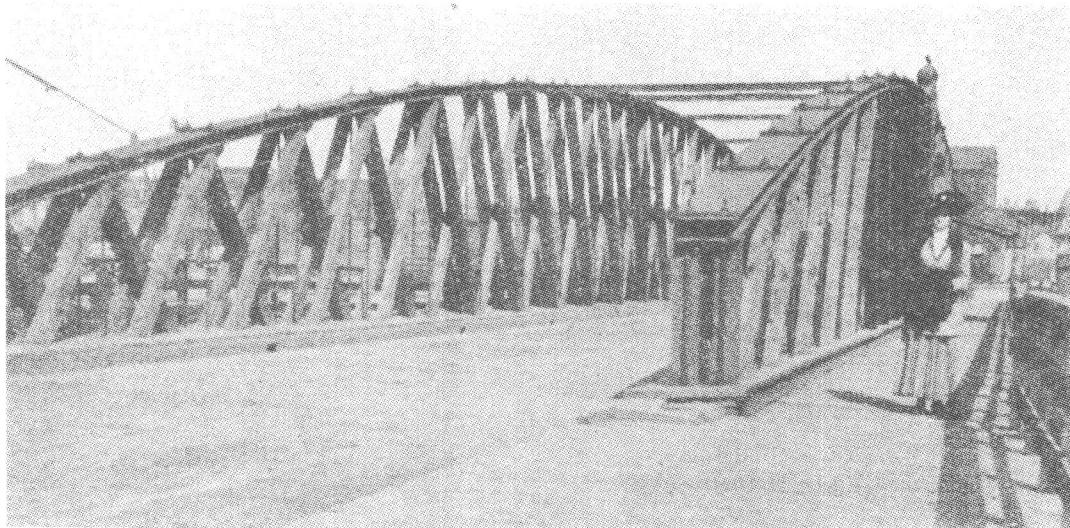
WEBSTER AVENUE BRIDGE, CHICAGO 文獻15
